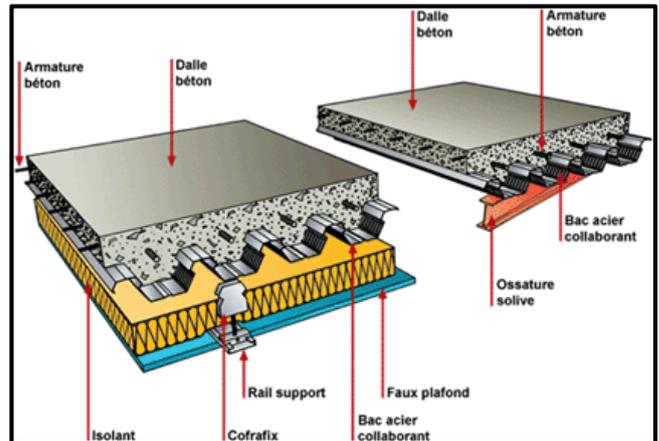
Schéma d'un plancher collaborant Source : guide béton
